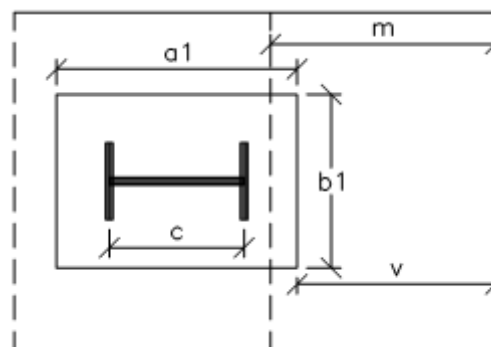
Vuelo de cálculo en una zapata con pilar metálico.
